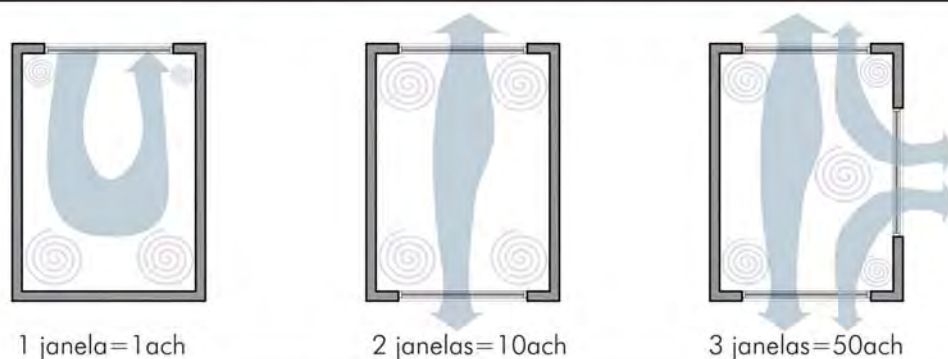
PLANTA BAIXA COM VARIAÇÕES DE ABERTURAS
